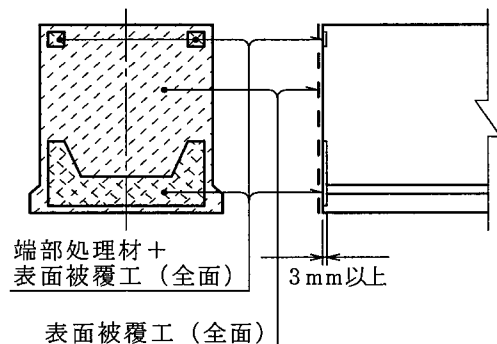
プレテン桁の桁端定着部におけるかぶり確保の例
